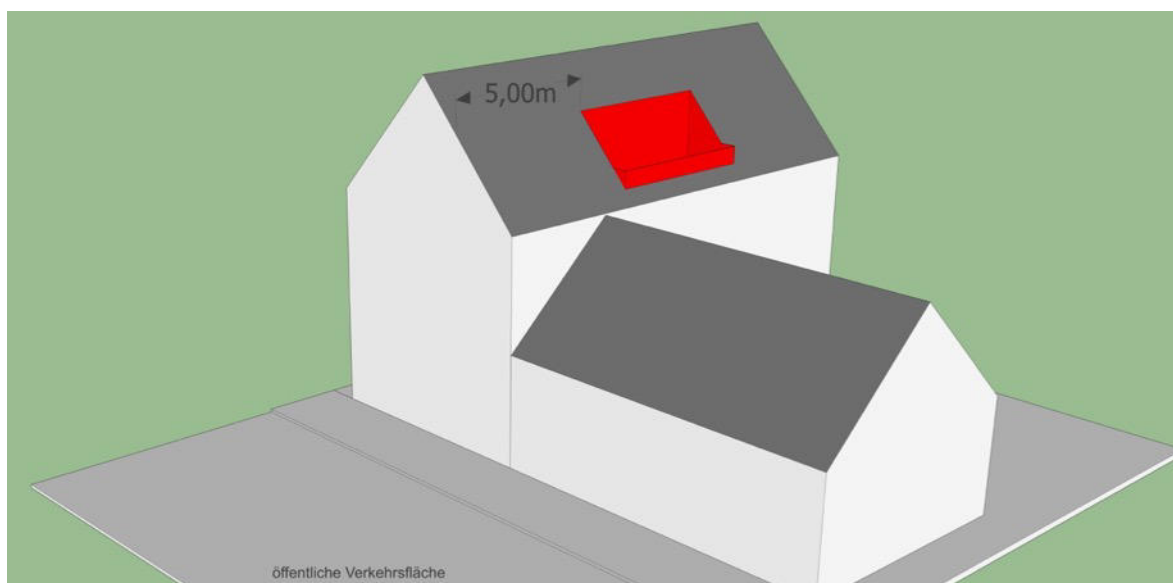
Mindestabstand des Dacheinschnittes zum Giebel bei giebelständigen Gebäuden gem. Festsetzung Nr. 14.4
